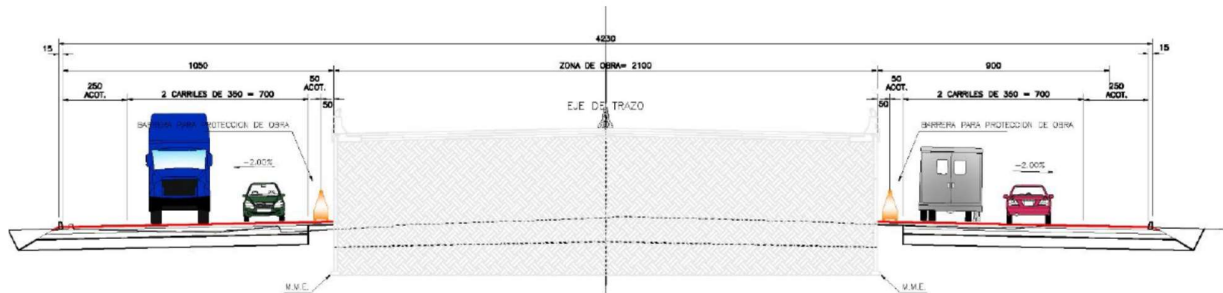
Sección transversal de la autopista en etapa final en zona de rampas con MME. (Fuente: plano de planta general de proyecto)
